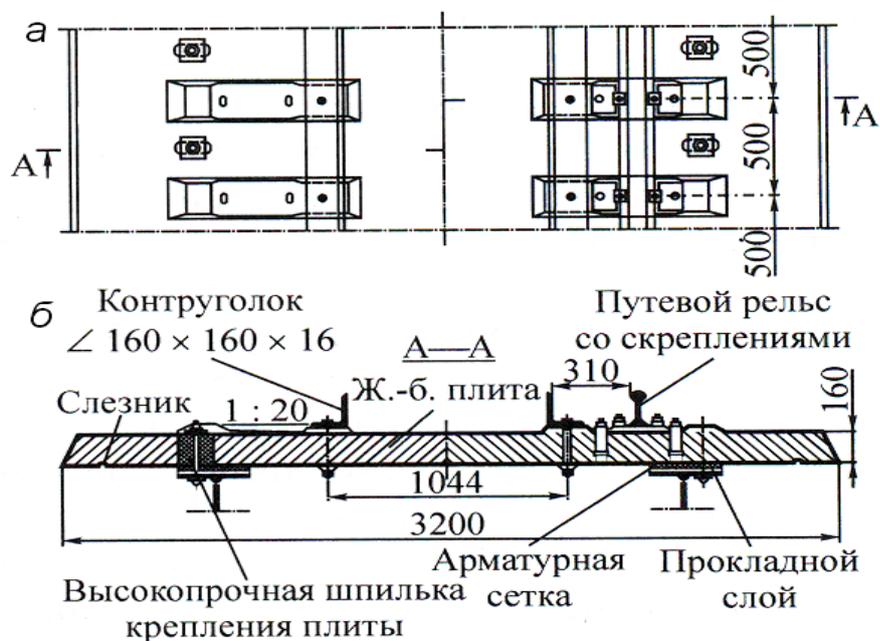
Конструкция мостового полотна на без балластной железобетонной плите: а – план ; б – поперечное сечение
